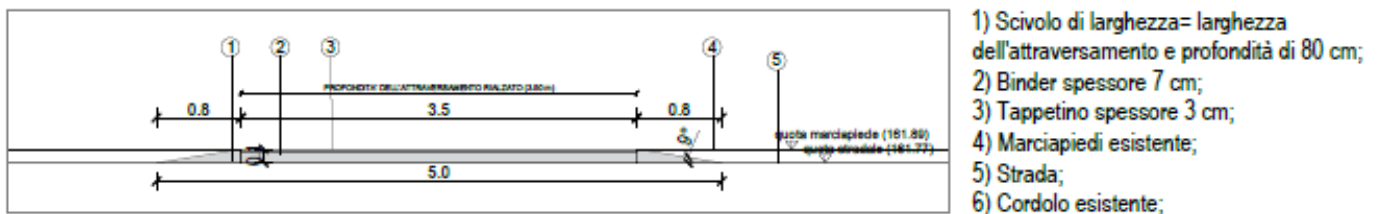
SEZIONE B-B – STATO DI PROGETTO ATTRAVERSAMENTO RIALZATO
